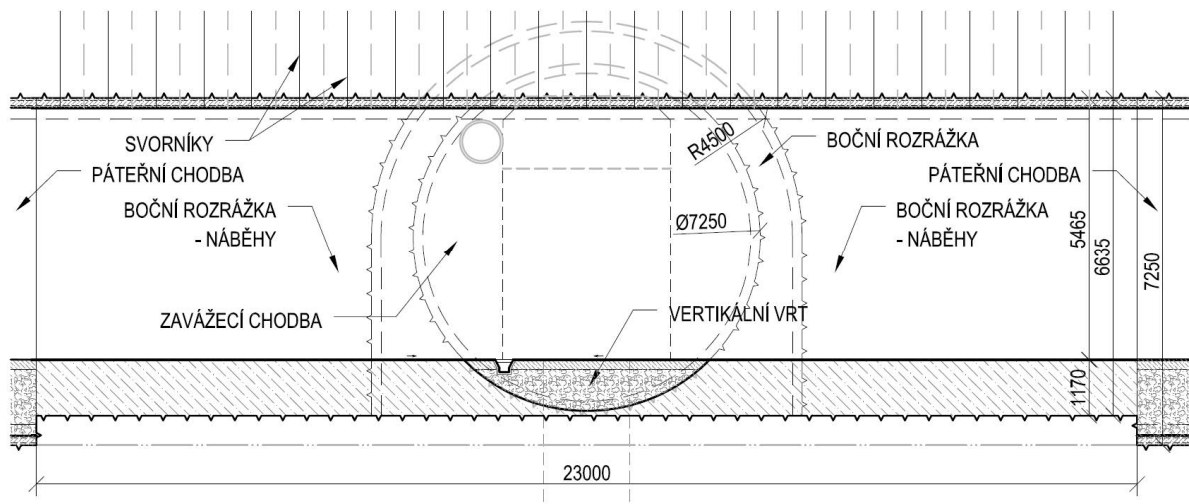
Půdorysné schéma ukládání – varianta D1 – VU, M
